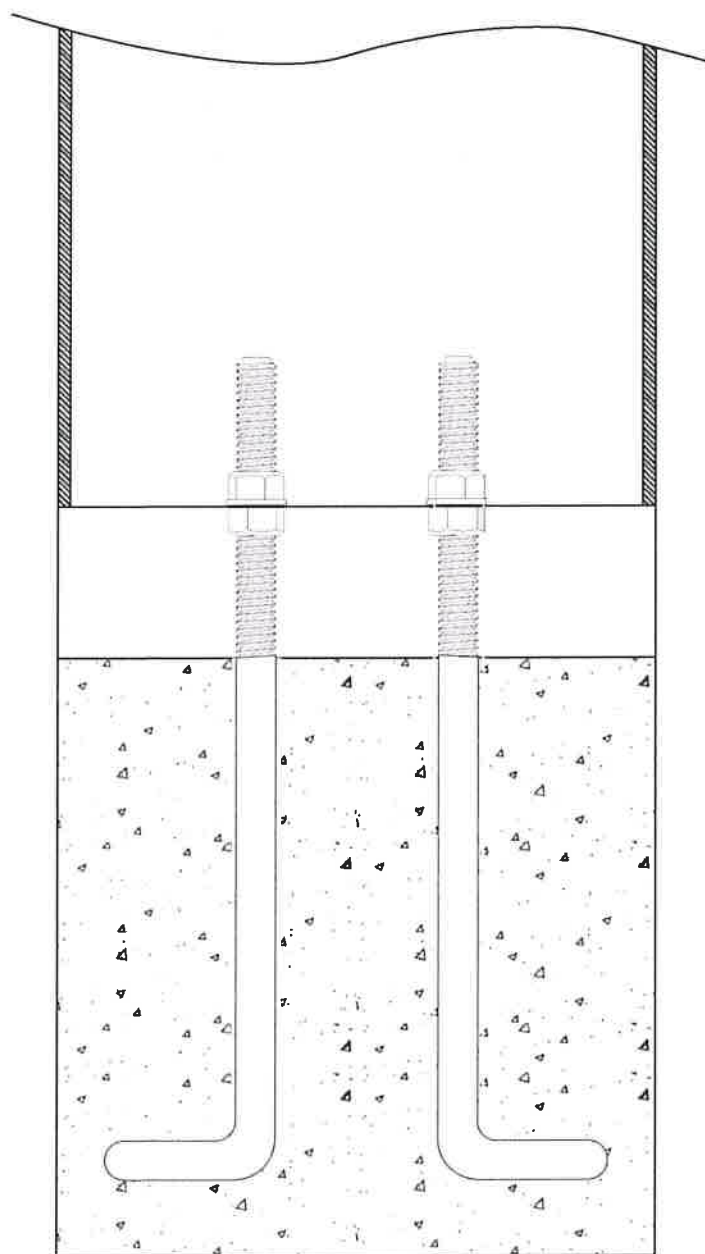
Montagem do parquímetro sobre o suporte inferior de fixação.
